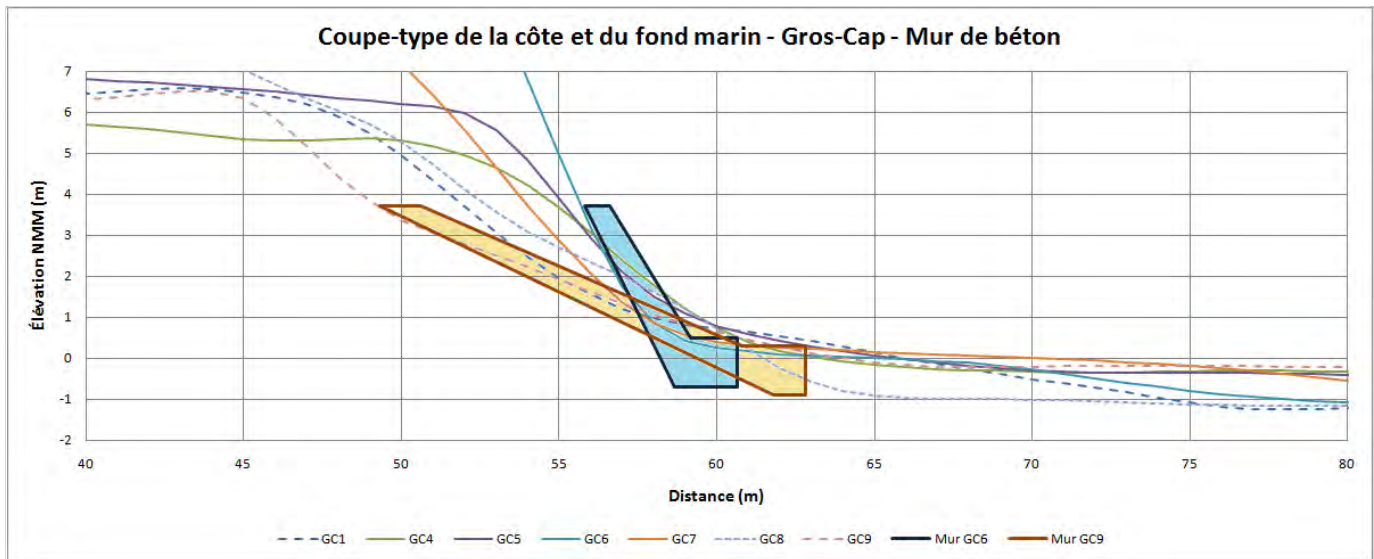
Coupe type d'une protection en béton armé du pied des falaises de Gros-Cap
